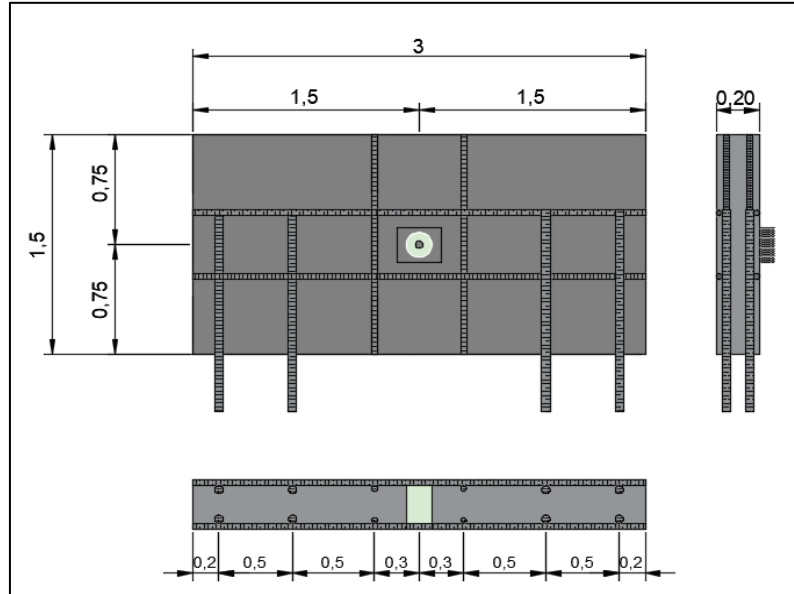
Esquema panel prefabricado Modelo 1. Fuente: Propia
